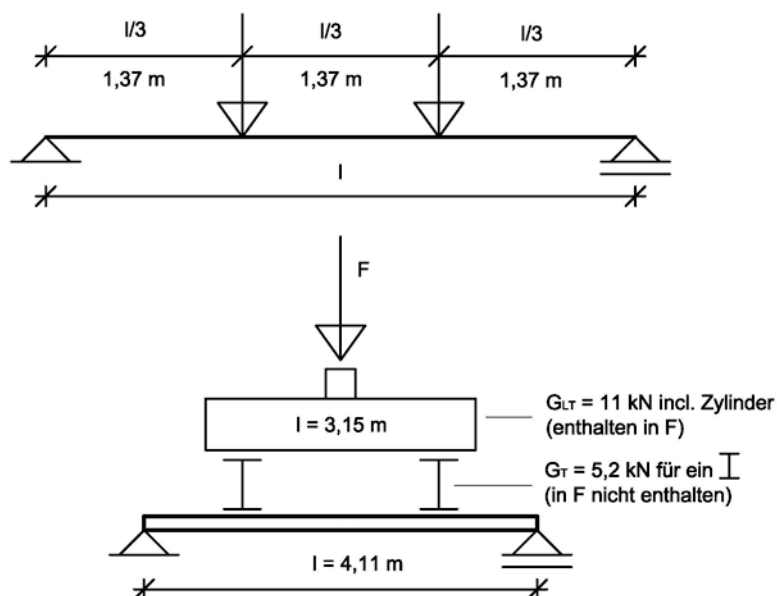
Belastungsanordnung und Einrichtung Stahlbetondeckenplatte 21120
